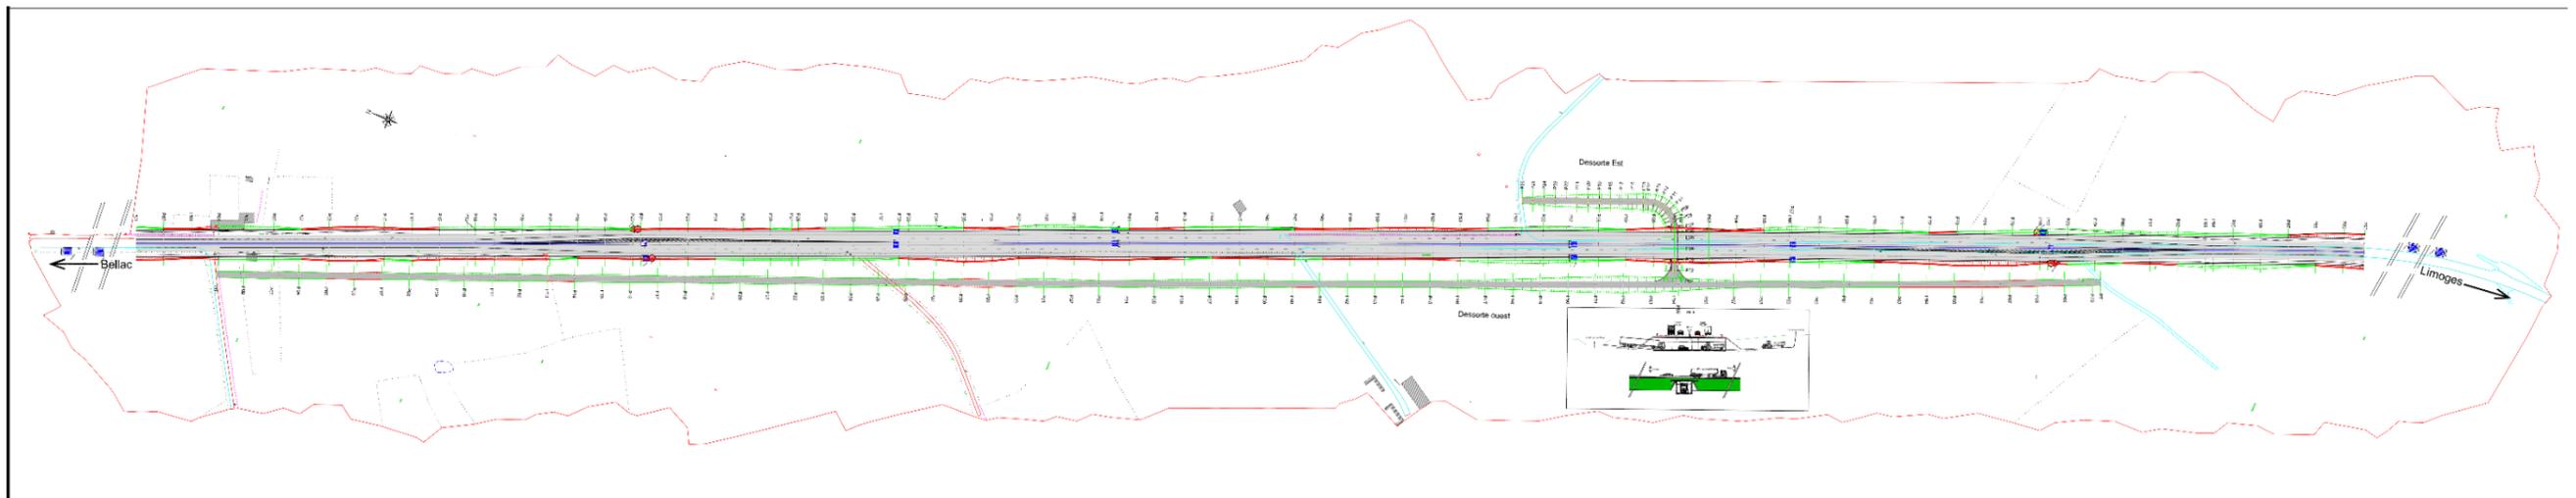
Variante Chamborêt créneau en place avec élargissement de part et d'autre, vue en plan
